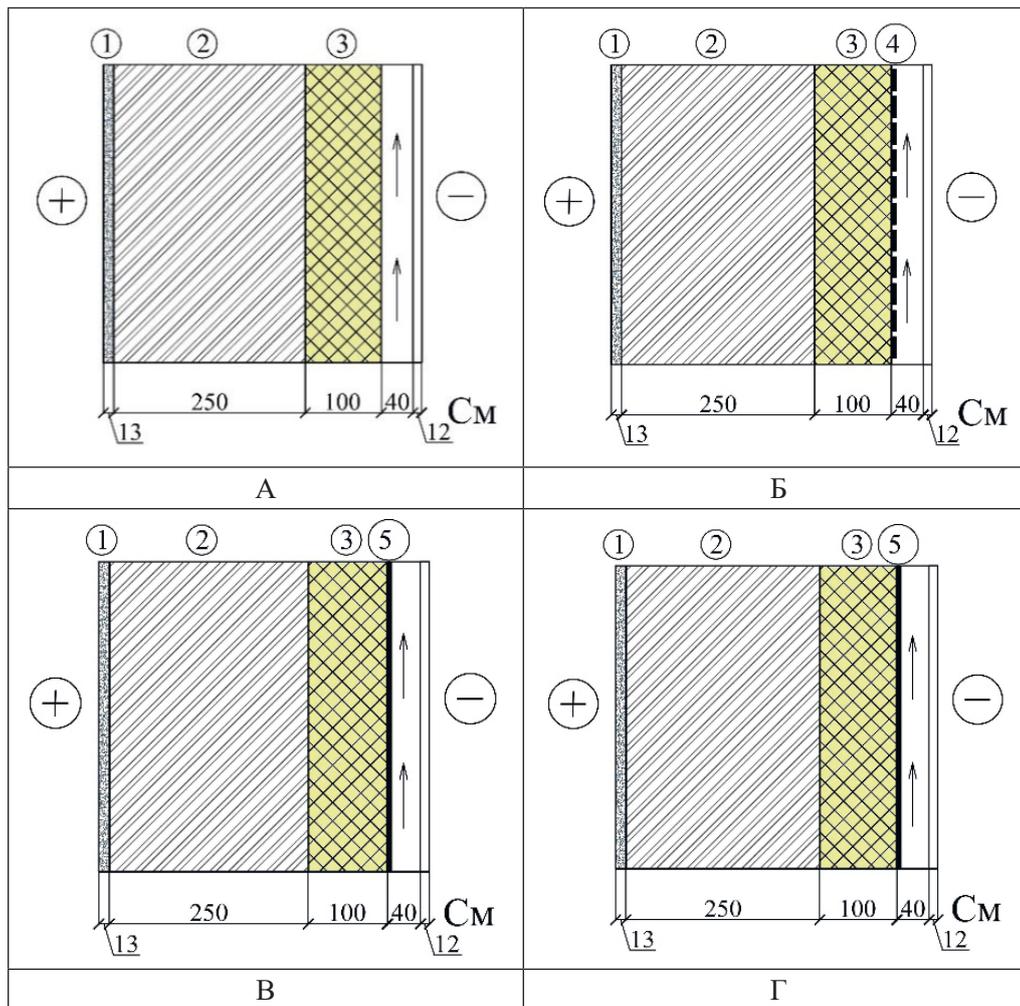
Расчетная схема вариантов рядового сечения конструктивного решения наружной стены с вентилируемым фасадом
